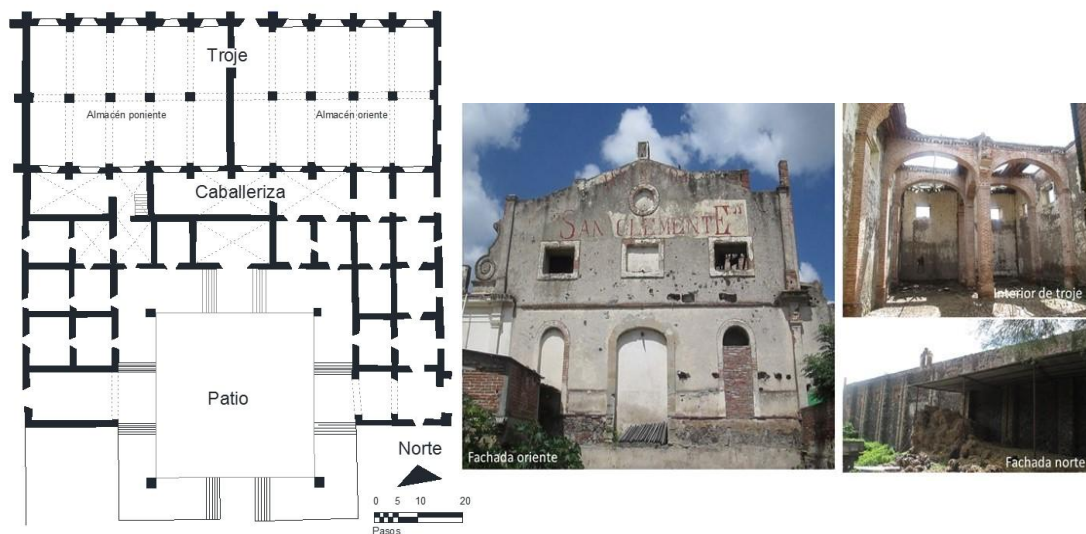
Planta de la Hacienda de San Clemente (izq) y fachada oriente e interior de la troje (der).
